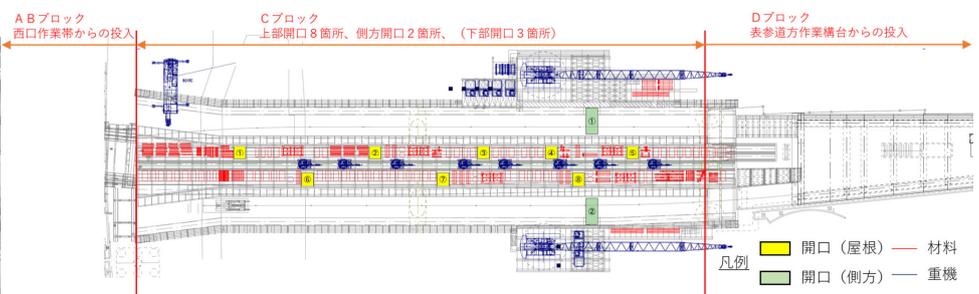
各ブロックの資機材動線および屋根上の重機・資機材配置図
